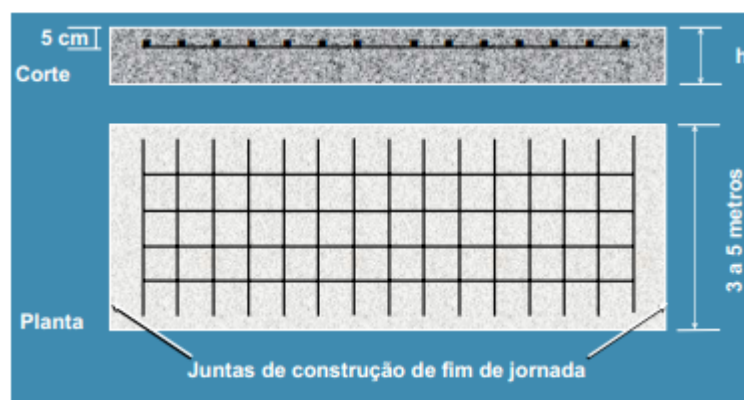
Pavimento de Concreto de Armadura Contínua Sem Função Estrutural
